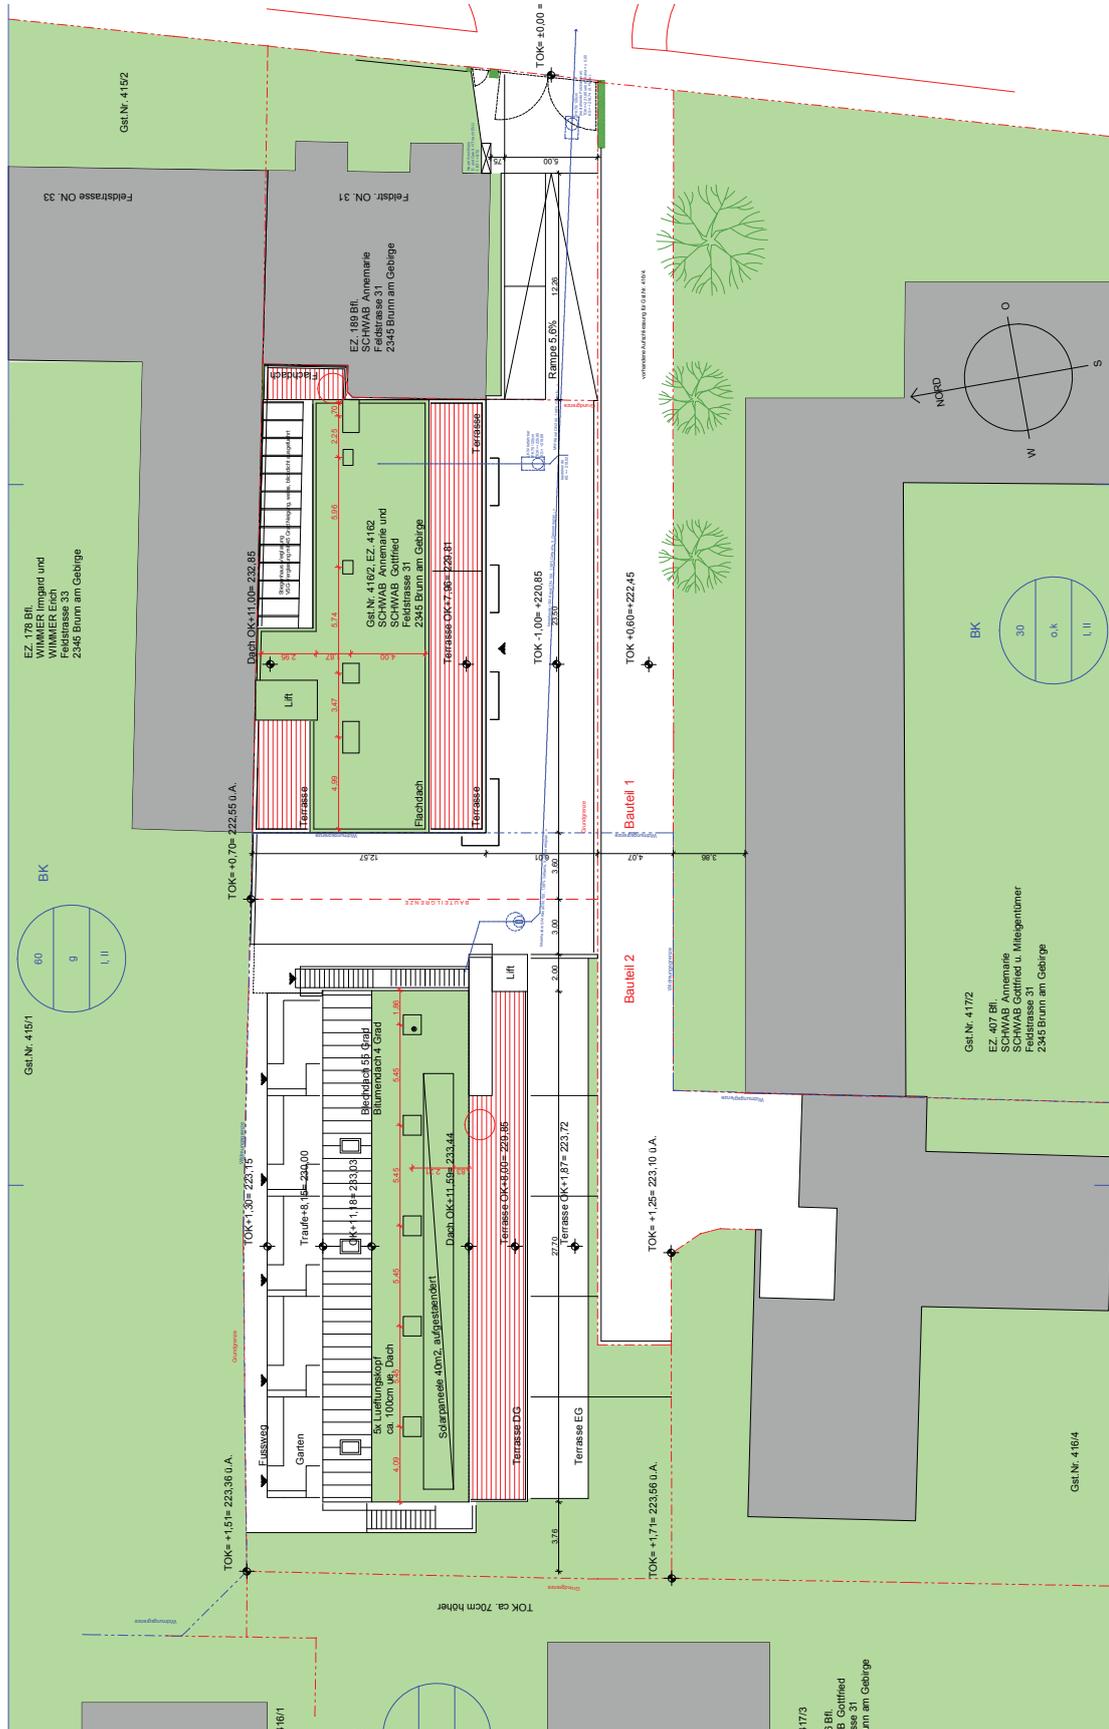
Lageplan Wohnhausanlage Feldstraße, Brunn am Gebirge, Quelle: Archiv a-plus Architektur
